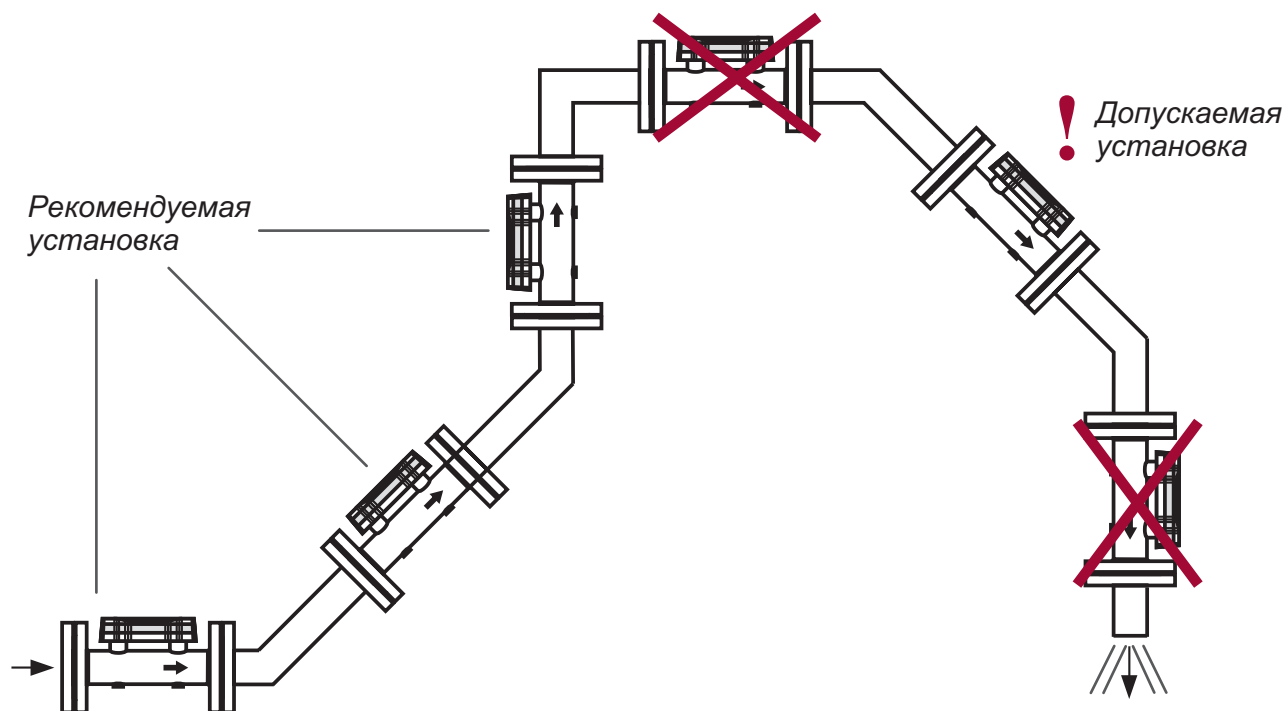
Рекомендуемая установка расходомера в трубопровод
